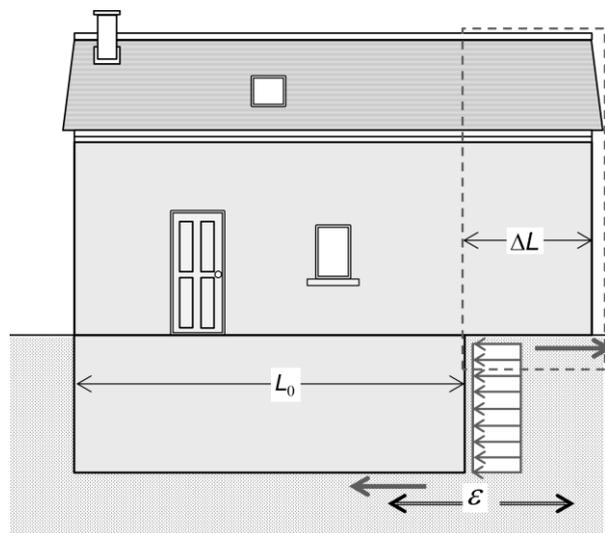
exemple de sollicitations supplémentaires sur la partie enterrée
